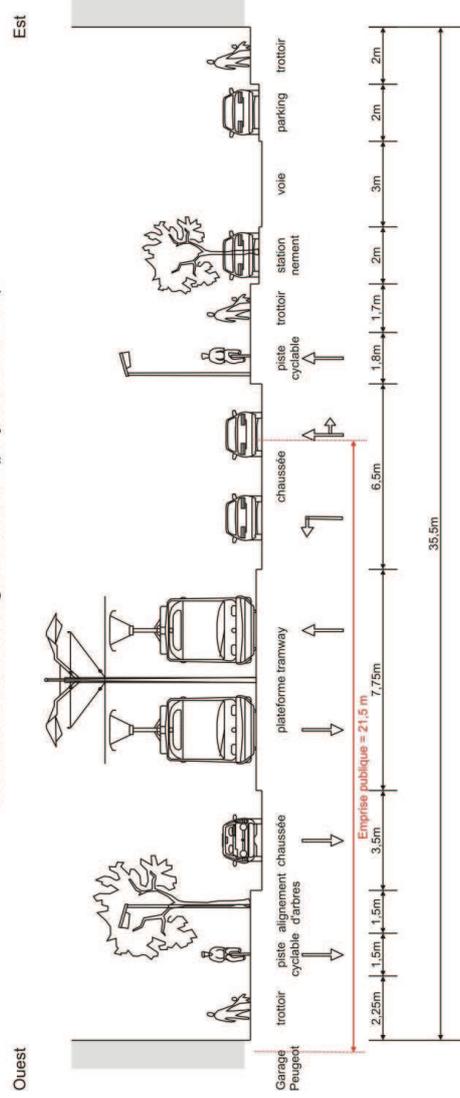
Situation projetée coupe 4 carrefour Molière / Stutzheim (site central)
